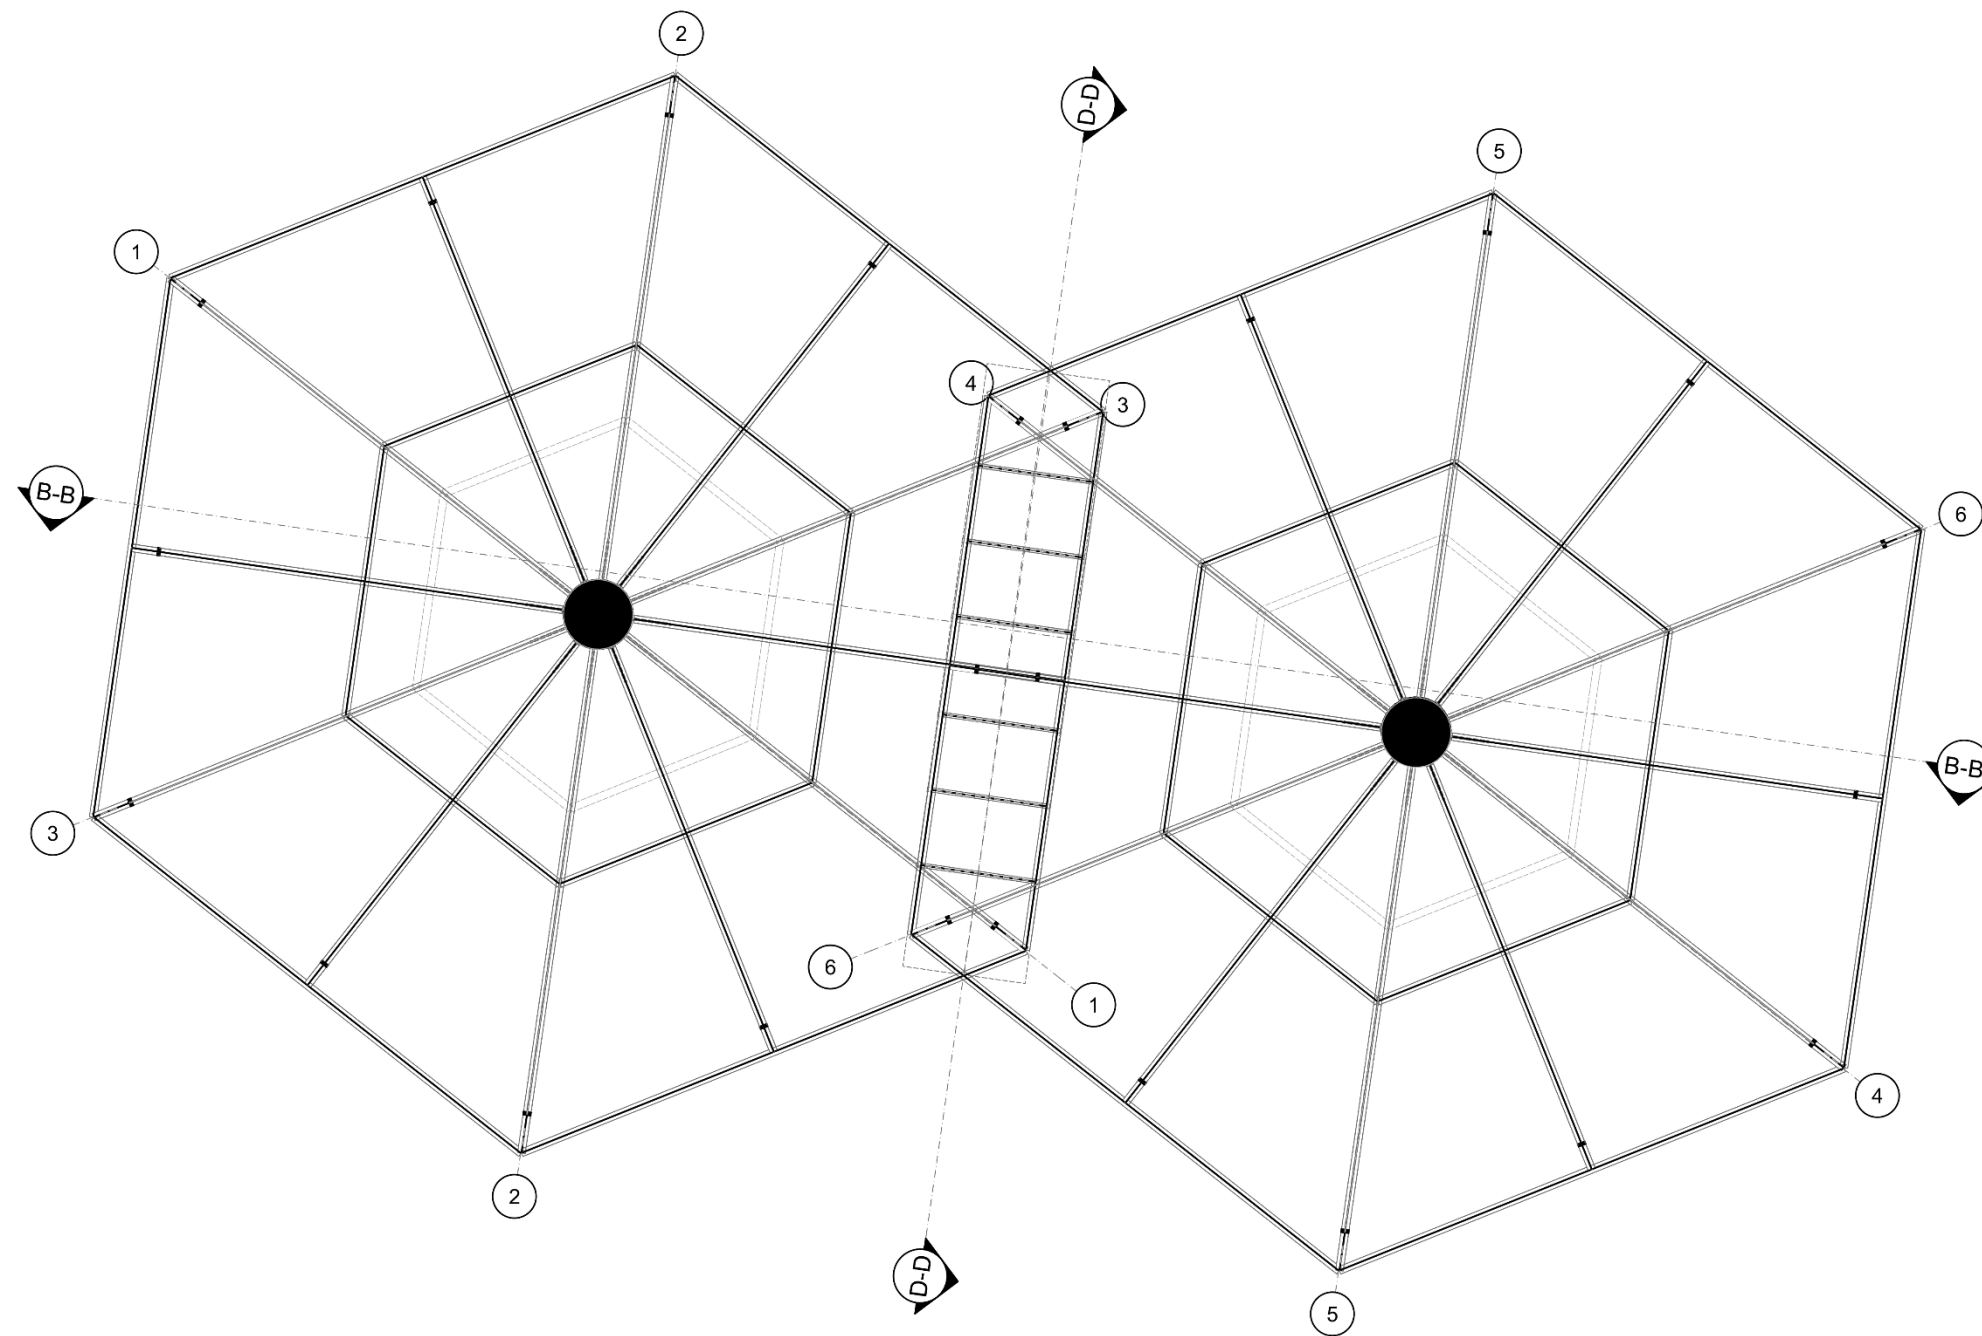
, Planta Estructural Edificio Deportivo, Propiedad Personal, Tomado 2023
